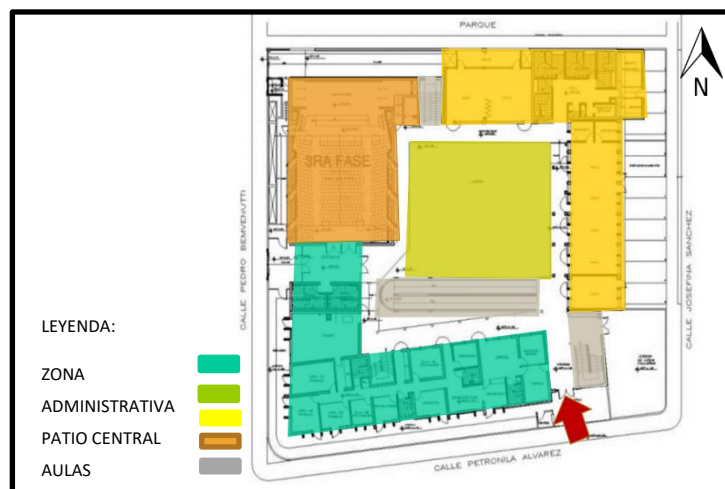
ZONIFICACIÓN EN PLANTA CEBE ANN - SULLIVAN
